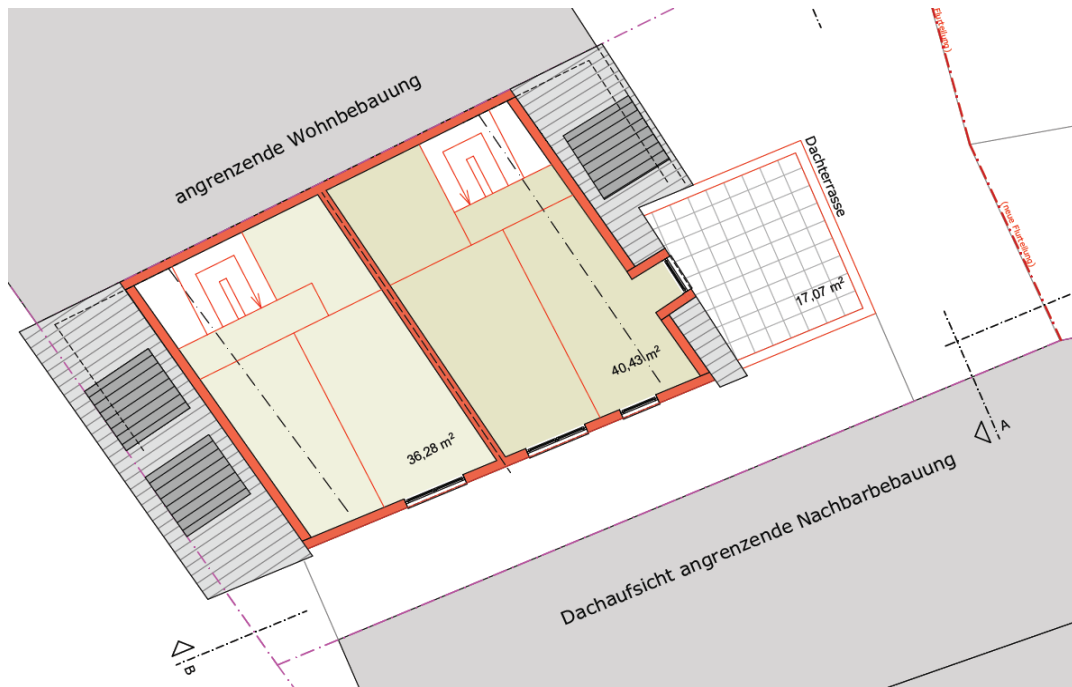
2. Dachgeschoss mit den WE 2 u. WE 3, Voranfrage [REDACTED] v. 08.12.2025
